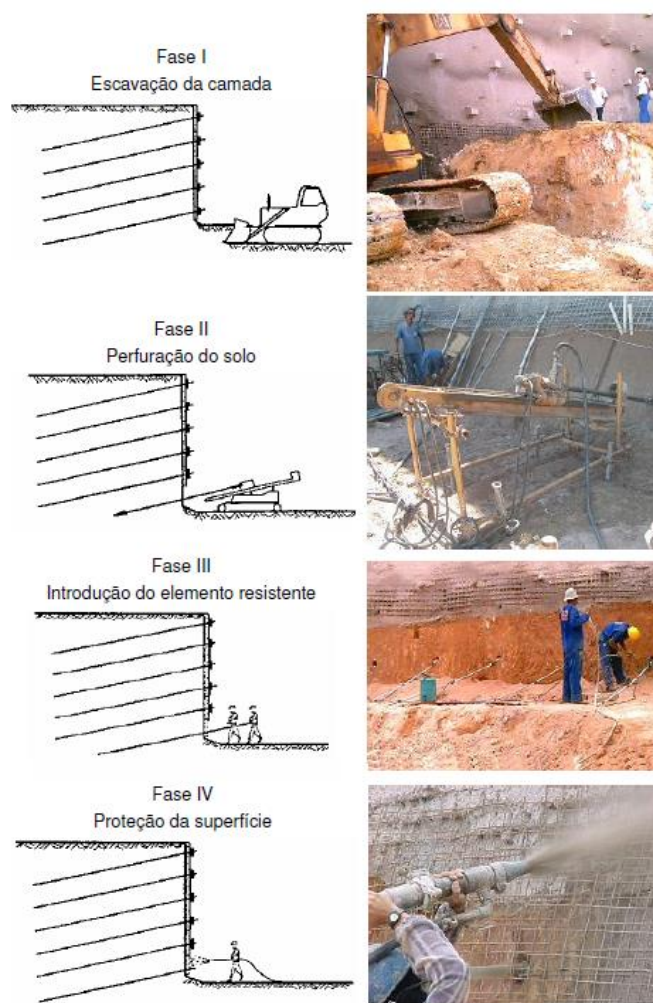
Etapas construtivas de muros de solo grampeado (adaptado de Clouterre, 1991)
